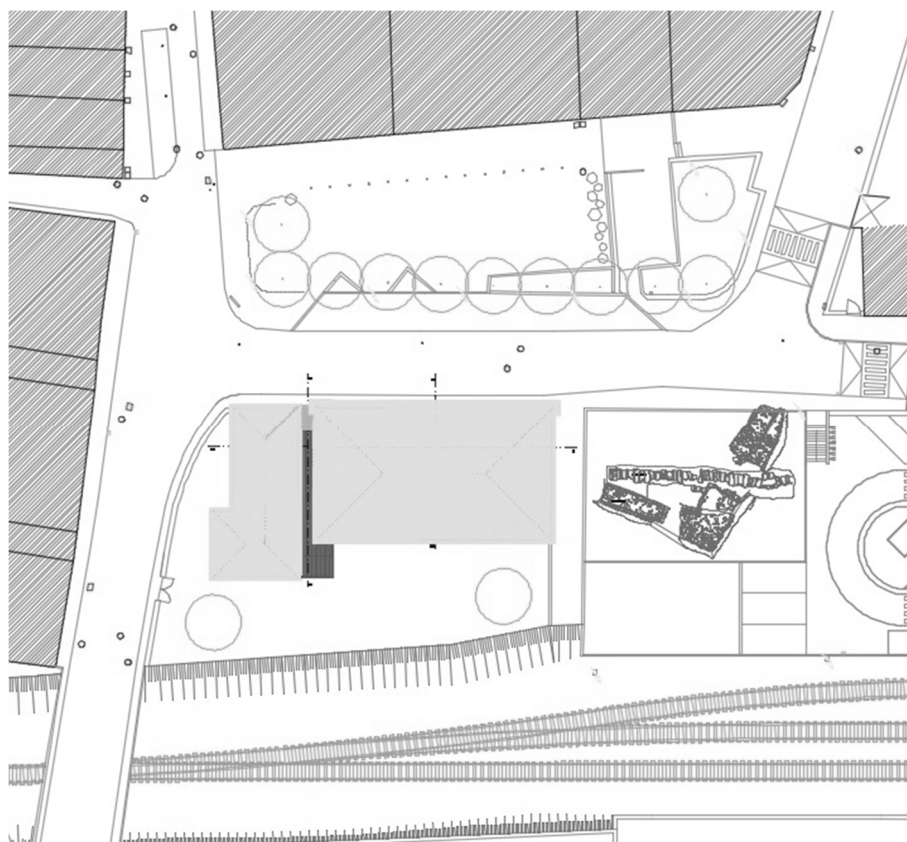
Planta de implantação (S/escala) – (Autor)
